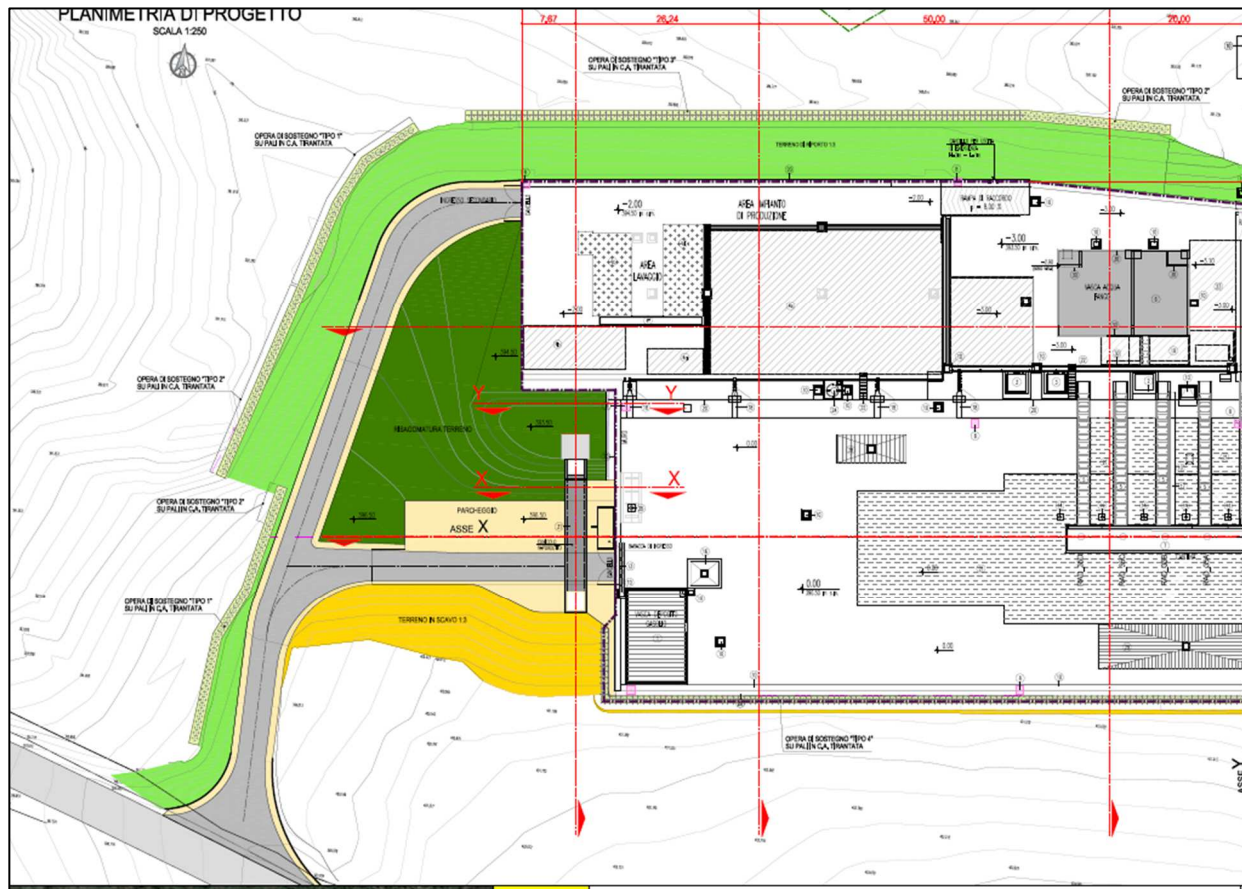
Disposizione delle opere di stabilizzazione, visibili ai bordi dell'area (opere di sostegno Tipo 1 e Tipo 2) da R35034_Pprog - Planimetria di progetto.
